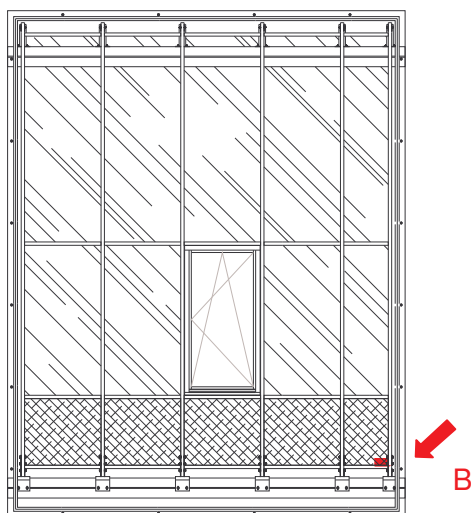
Schema delle infiltrazioni riscontrate nel campione alla pressione di 900 Pa (prospetto vista interna)
